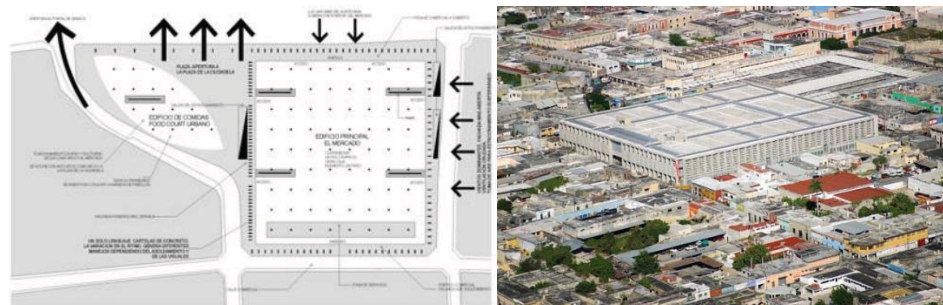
PLAN DE RECONSTRUCCIÓN Y PRIMERA FASE YA REALIZADA
